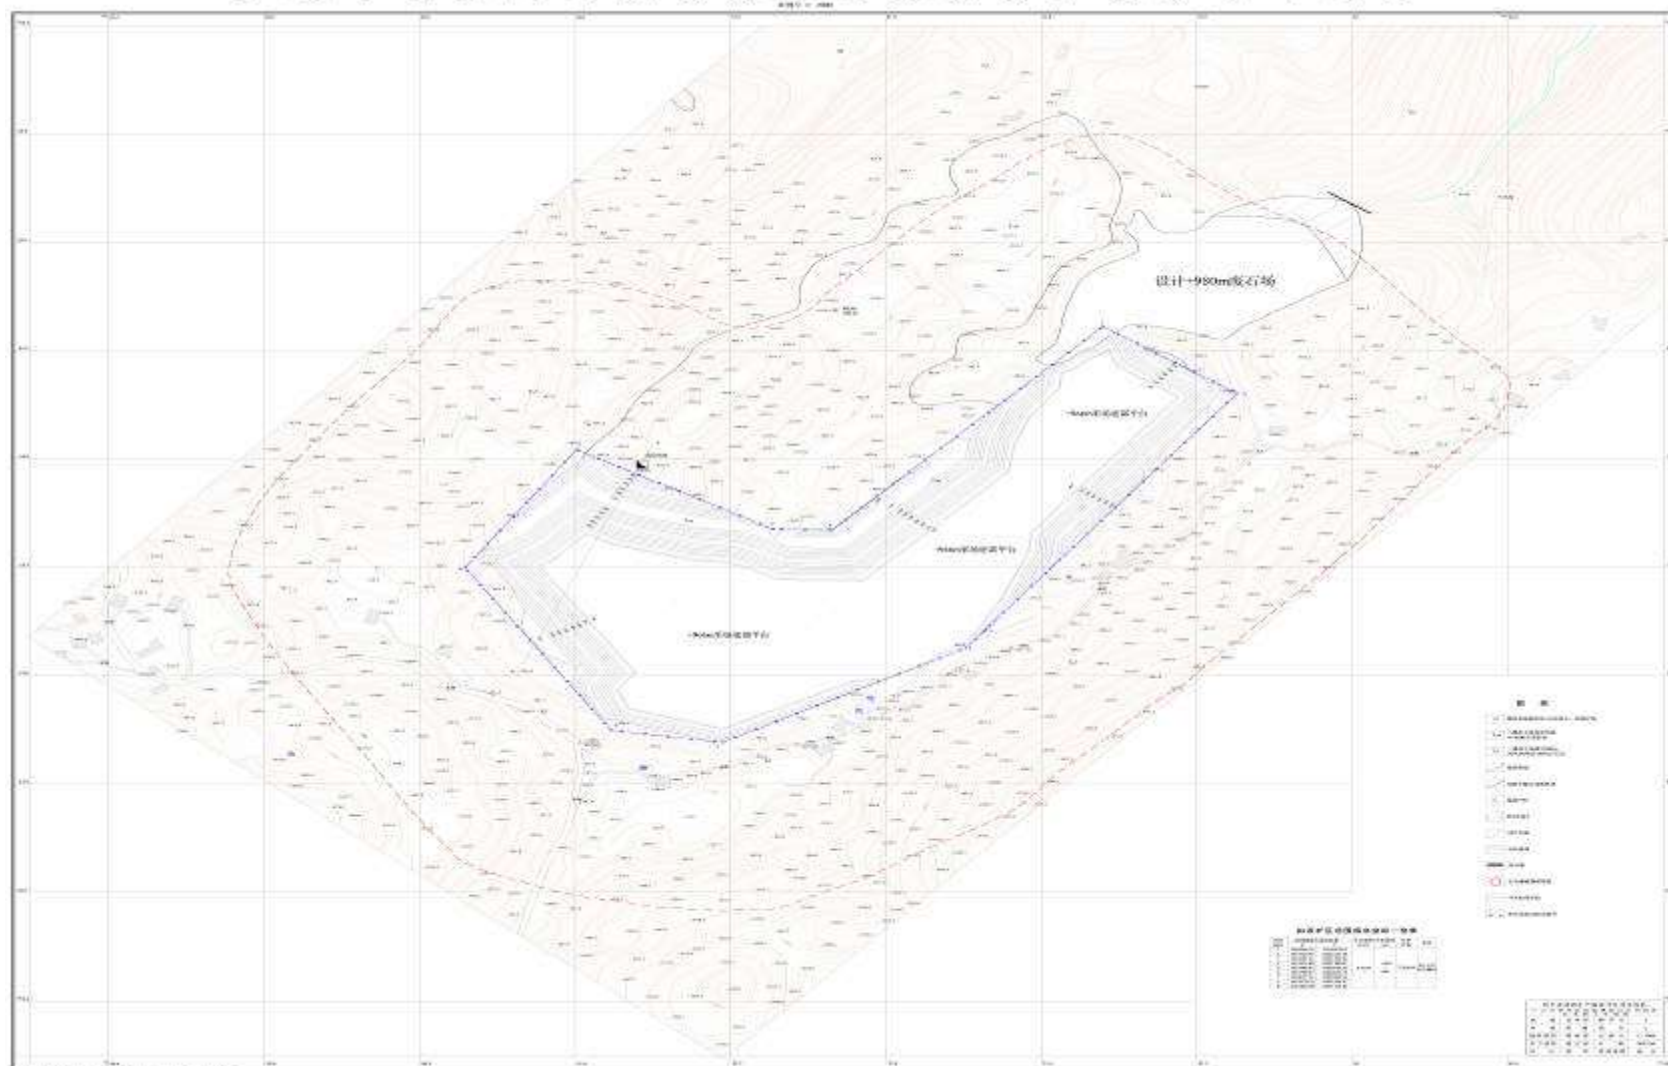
张公石灰岩矿开采终了平面图（引自开发利用方案）
